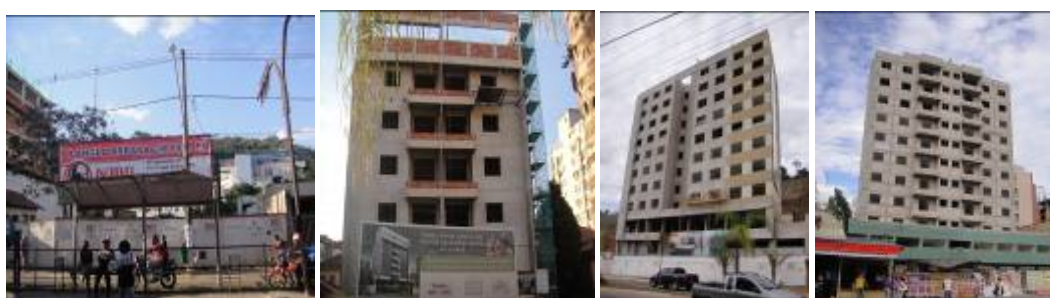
, 26 e 27 – Edificações verticais sendo construídas na Avenida Santa Rita. Fonte: Arquivo pessoal (maio 2011).
